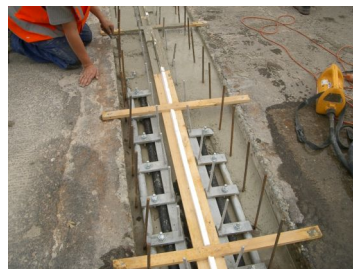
Bochtstukken met extra ankers, aanstorten sparing met staalvezelbeton
